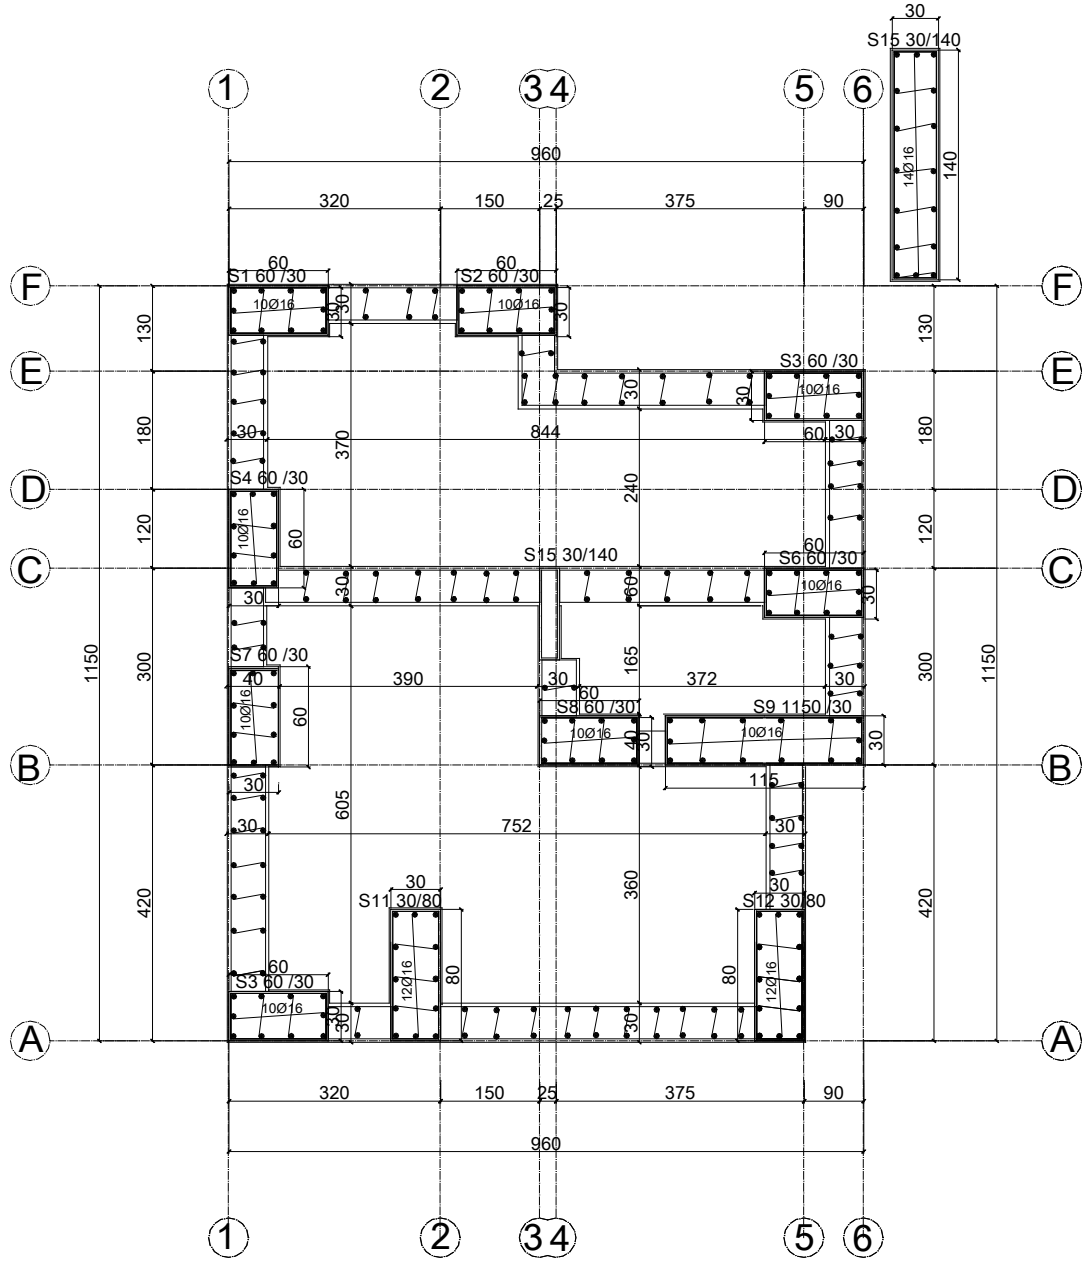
Kolon aplikasyon planı dış ölçülendirmesi
